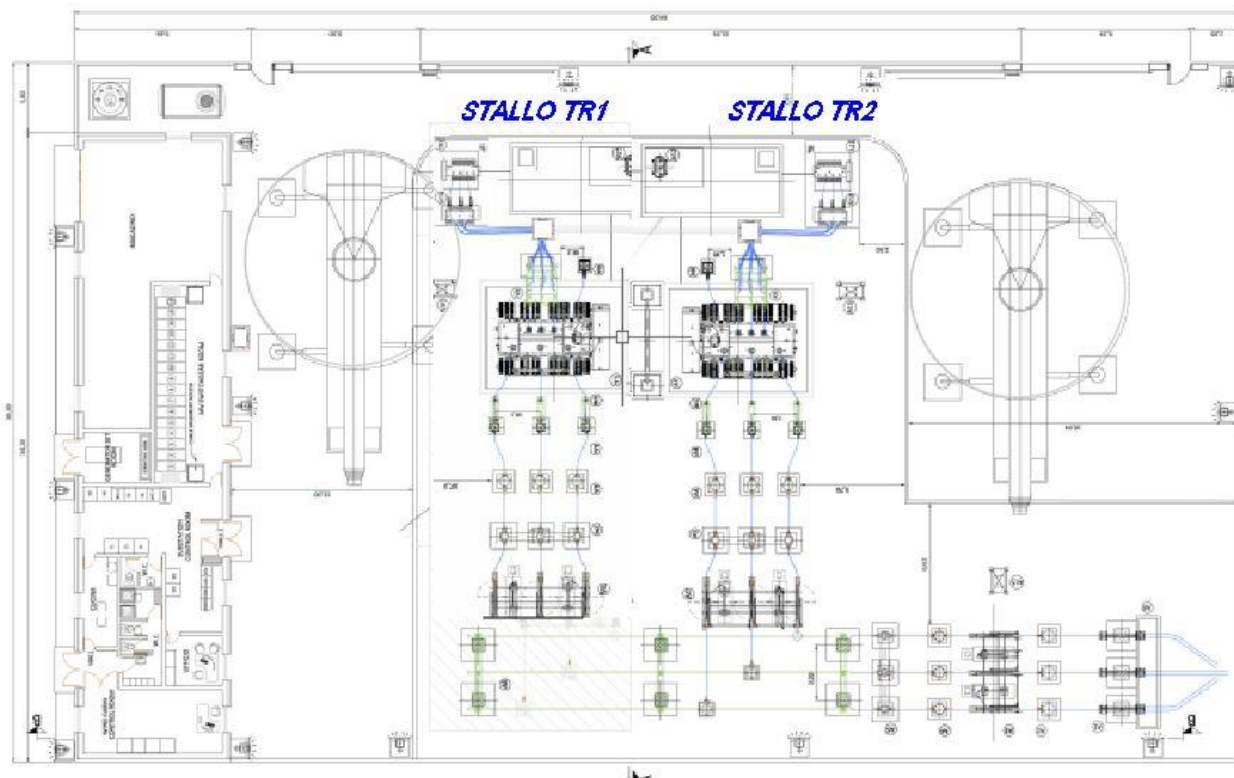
Esempio di schema planimetrico della Sottostazione di misura e consegna
